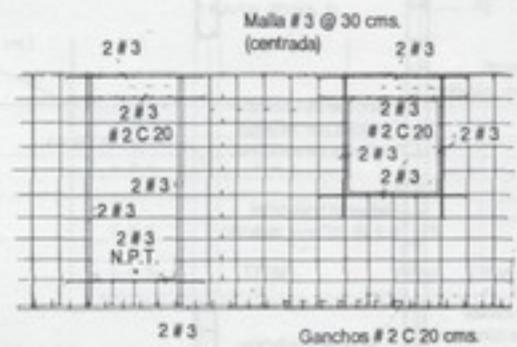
Elevación típica de pared concreto reforzado.
